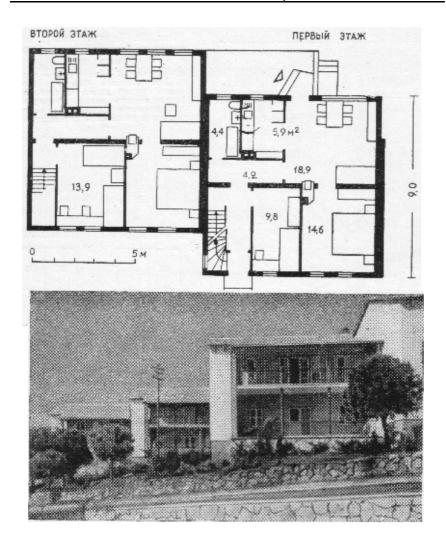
Поэтажные трехкомнатные квартиры блокированного дома (ФРГ) Жилая площадь квартиры первого этажа 43,3 M^2 , квартиры второго этажа — 47,7 M^2 . Вход общий для обеих квартир
